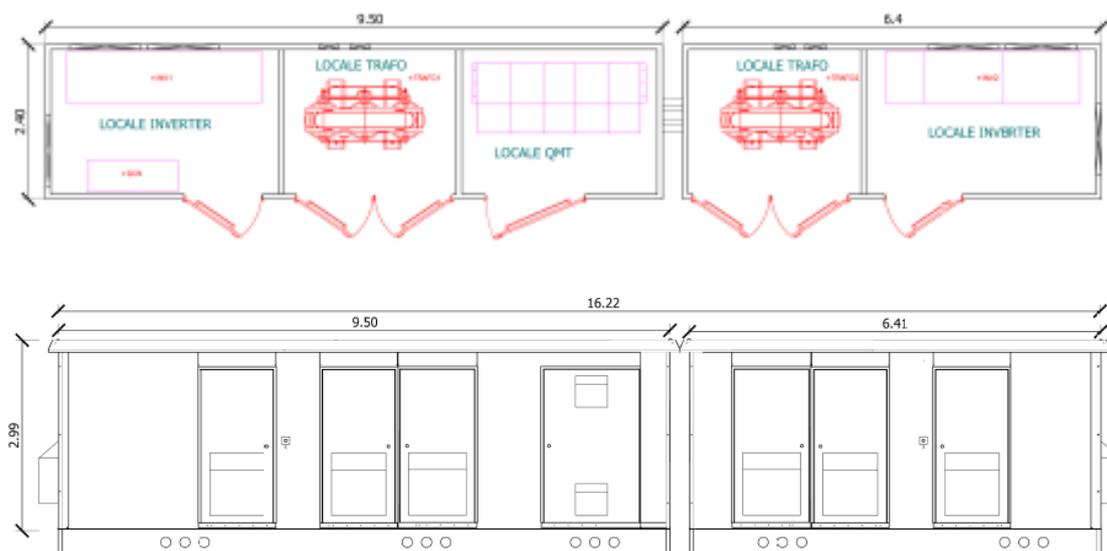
Pianta e prospetto cabina di conversione e trasformazione con due inverter
